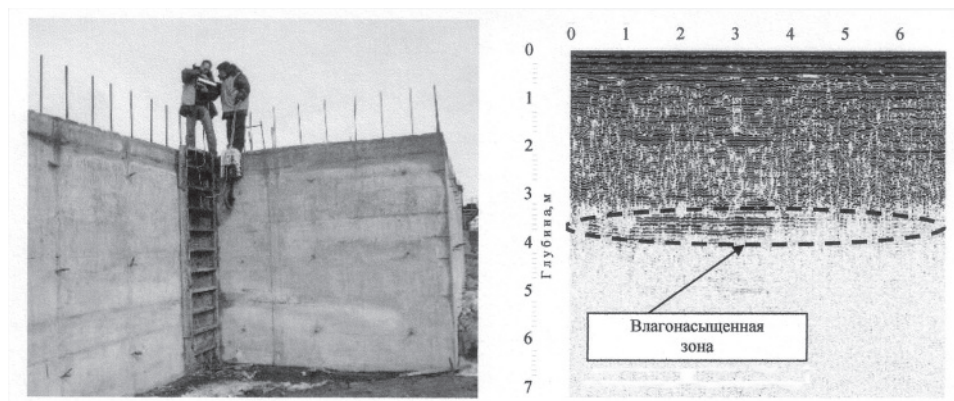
Георадарное зондирование по стенкам и кровле бетонных фундаментов под мельницы.
